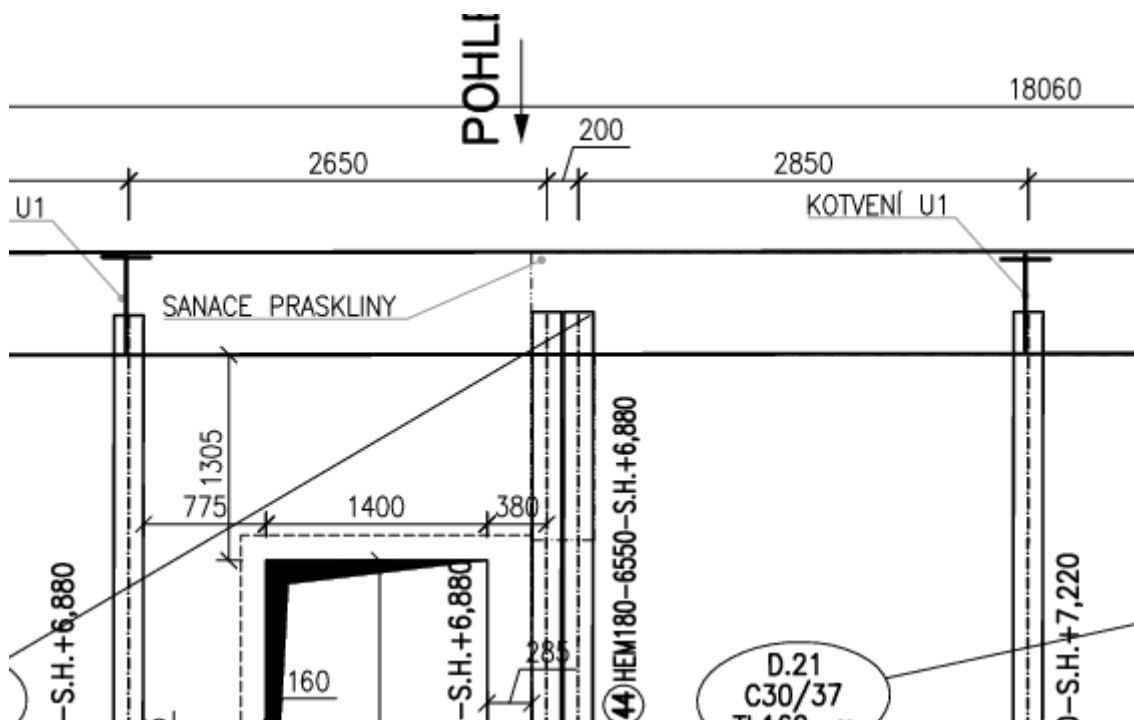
Výřez z výkresu D.1.1.06 PŮDORYS 5.NP - NAVRHOVANÝ STAV
